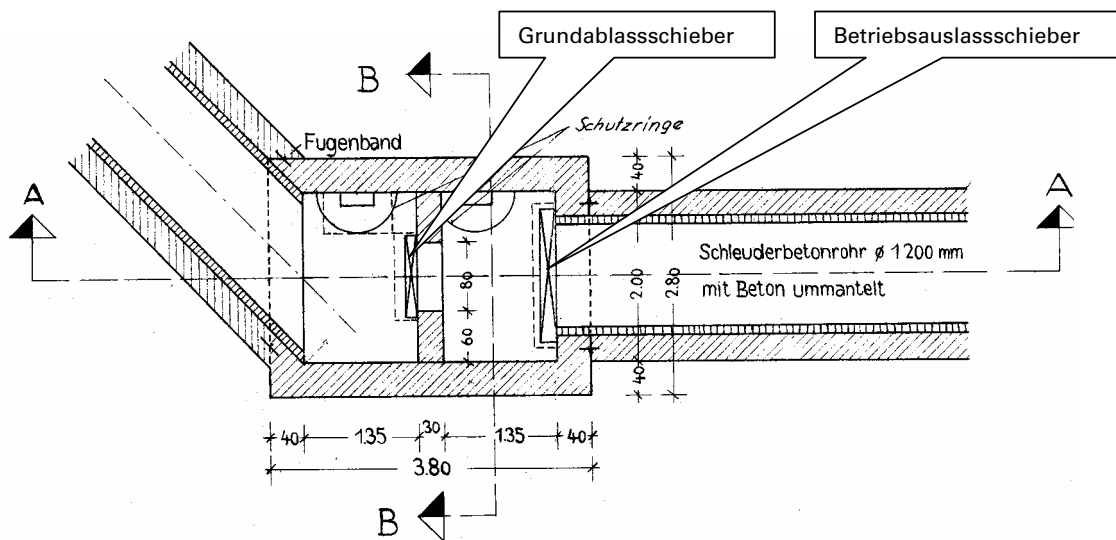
Grundriss Mönchsschacht, Hochwasserentlastungsanlage
